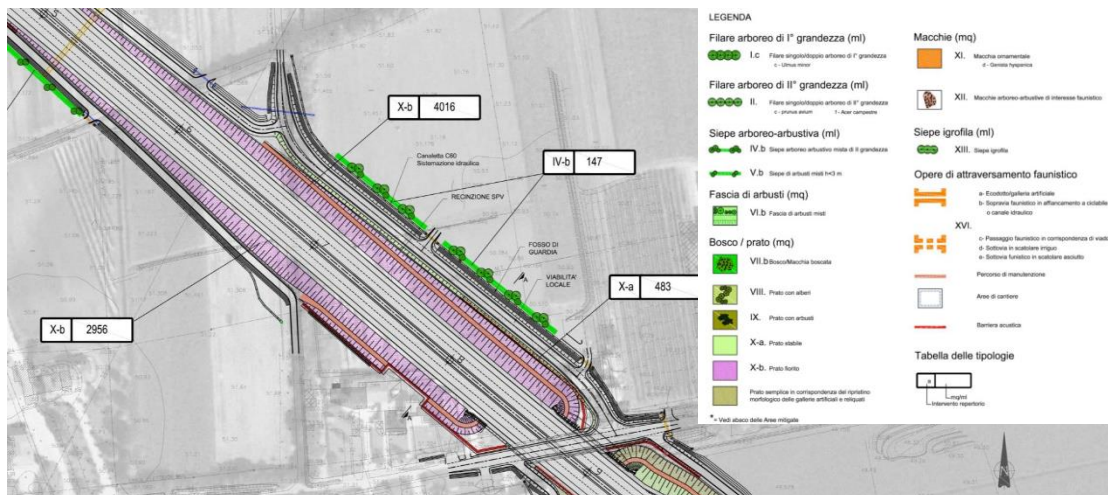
Estratto del progetto in variante – Collegamento parallelo a SPV.
